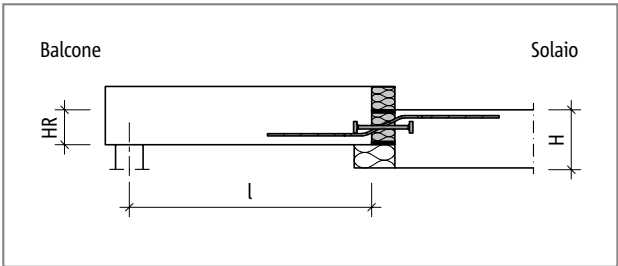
Schöck Isokorb® tipo QL-OD: schema statico
